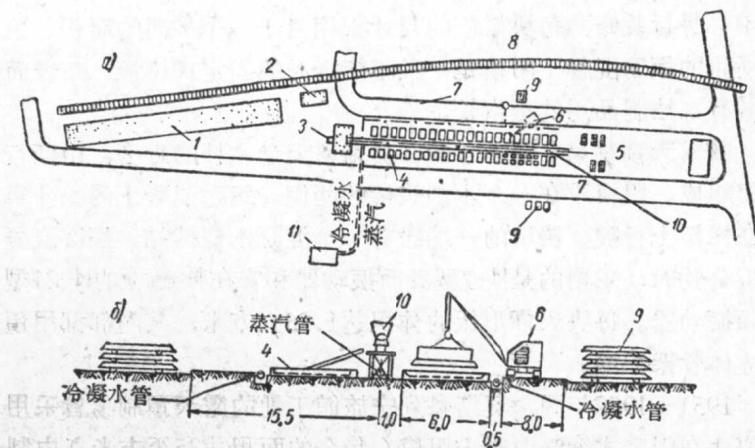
制造大型钢筋混凝土预制楼板的露天预制场示意图
